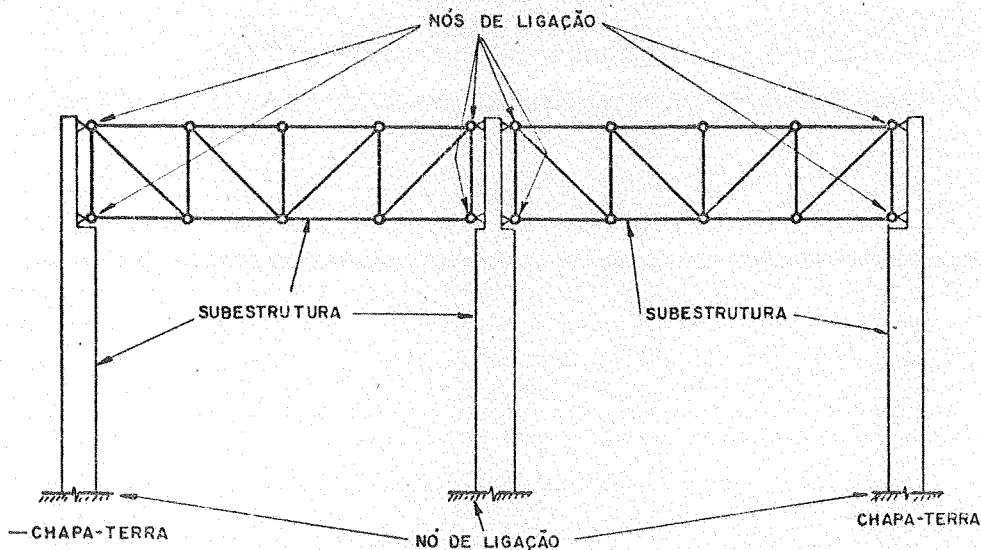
LIGAÇÃO DAS SUBESTRUTURAS.
